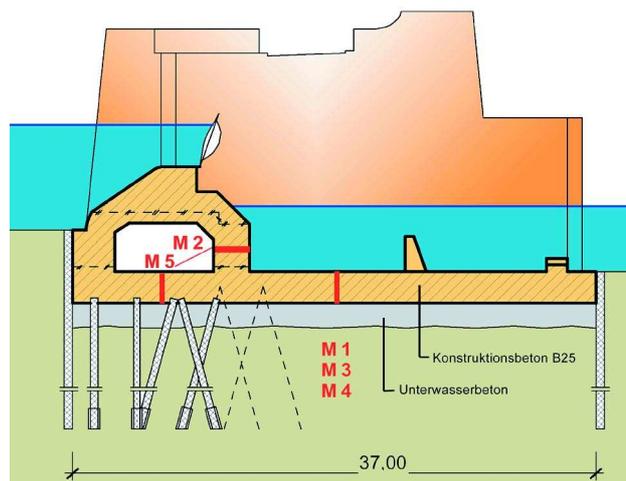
Querschnitt durch das Bremer Weserwehr
